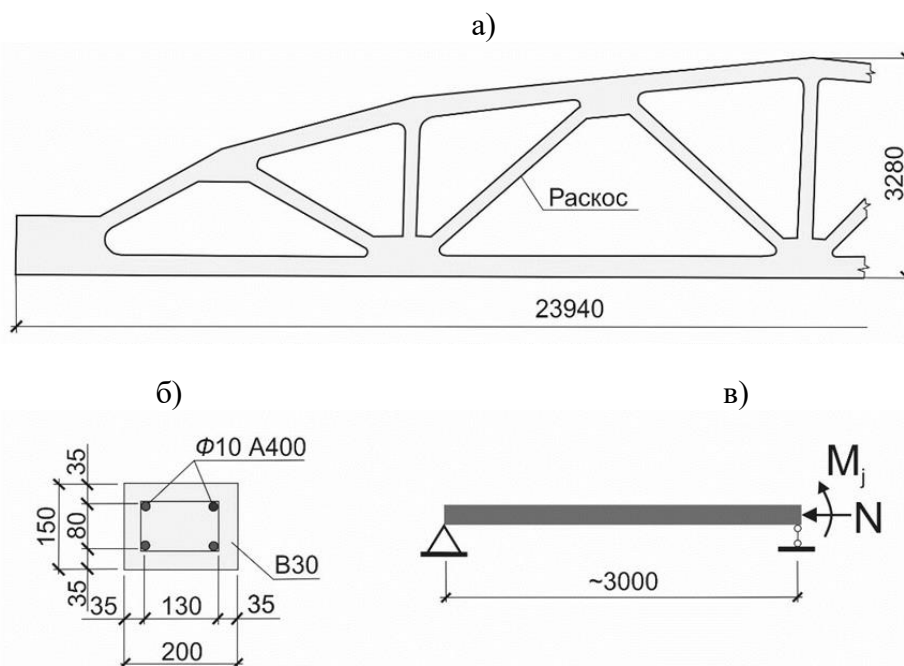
К определению деформационных критериев: раскосная железобетонная ферма (а), поперечное сечение рассматриваемого стержневого элемента (б) и его расчетная схема (в)
